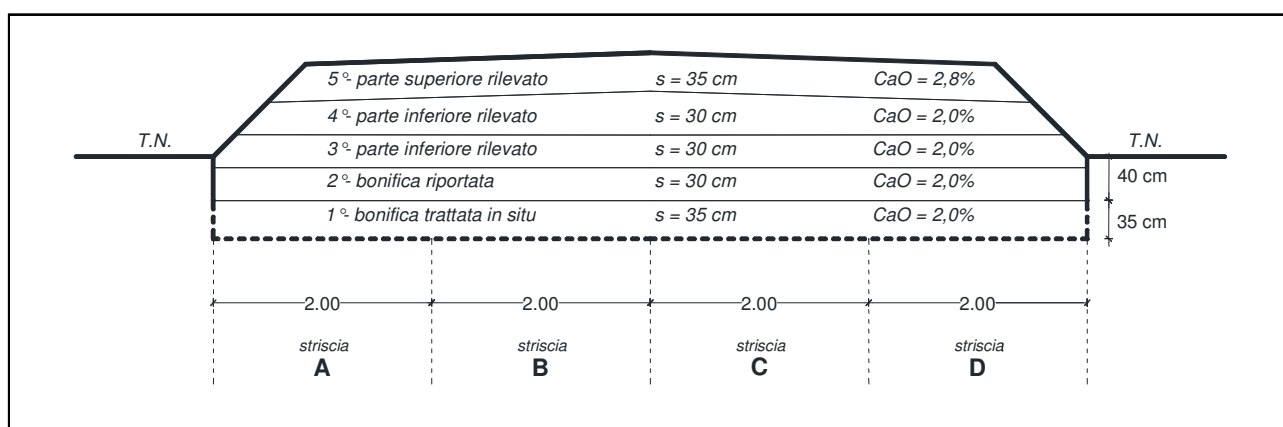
Schema del rilevato sperimentale, come previsto in progetto
